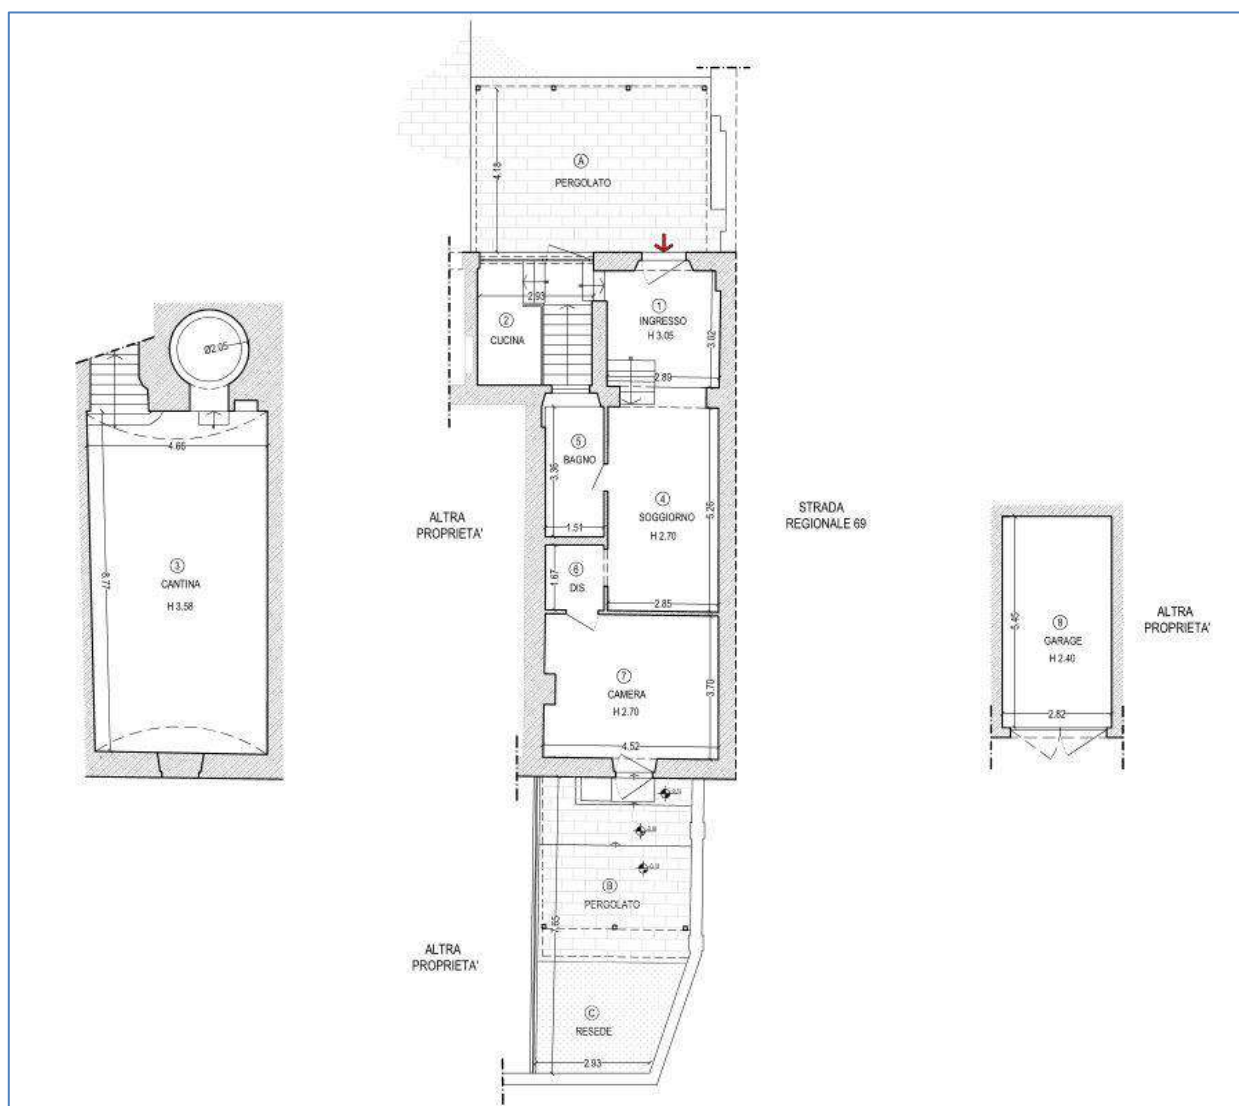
EDIFICIO A, ABITAZIONE E CANTINA - EDIFICIO C GARAGE
